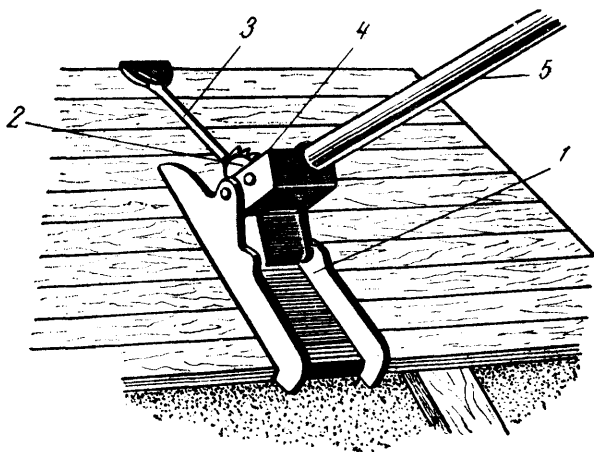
Рычажно-зубчатый сжим с храповым колесом и натяжным канатом.
